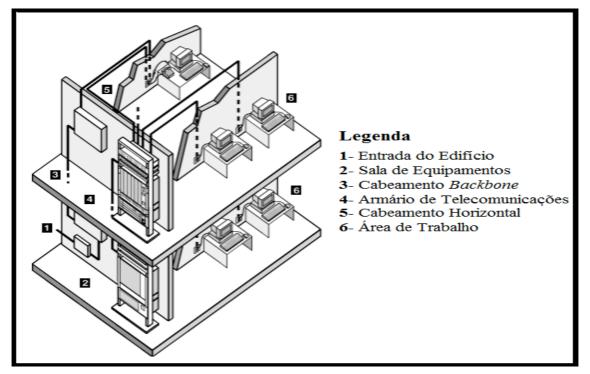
Sistema de cabeamento estruturado EIA/TIA 568
